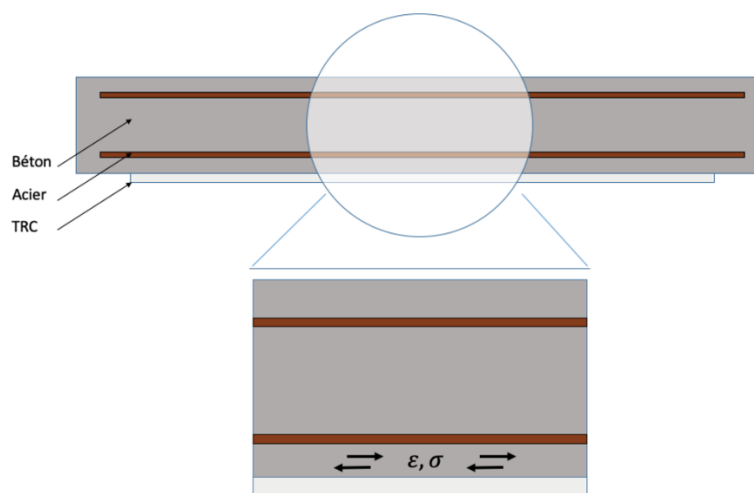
Schéma d'une poutre en béton armé avec un renforcement TRC
